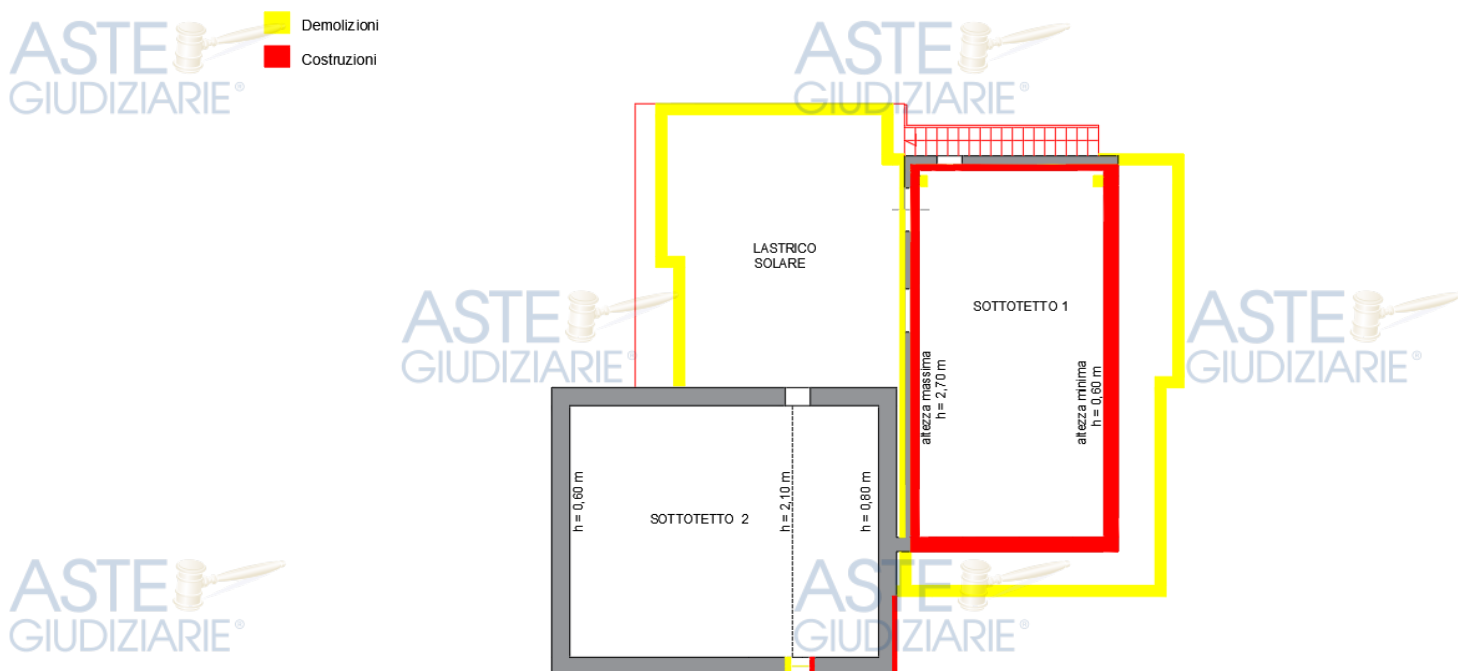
Confronto edilizio con C.E. n. 6/bis/2000 – pianta piano primo
